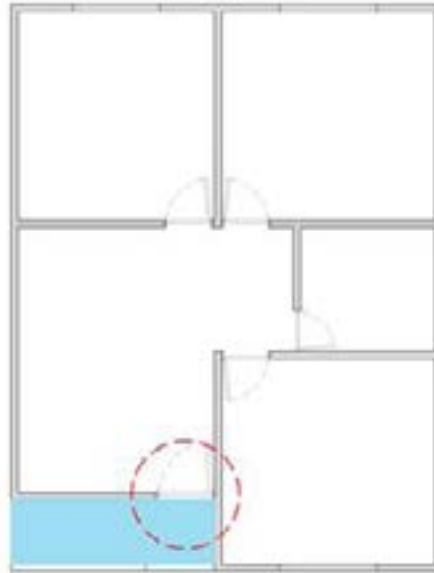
Planta esquema circulaciones Bloque No.10.
